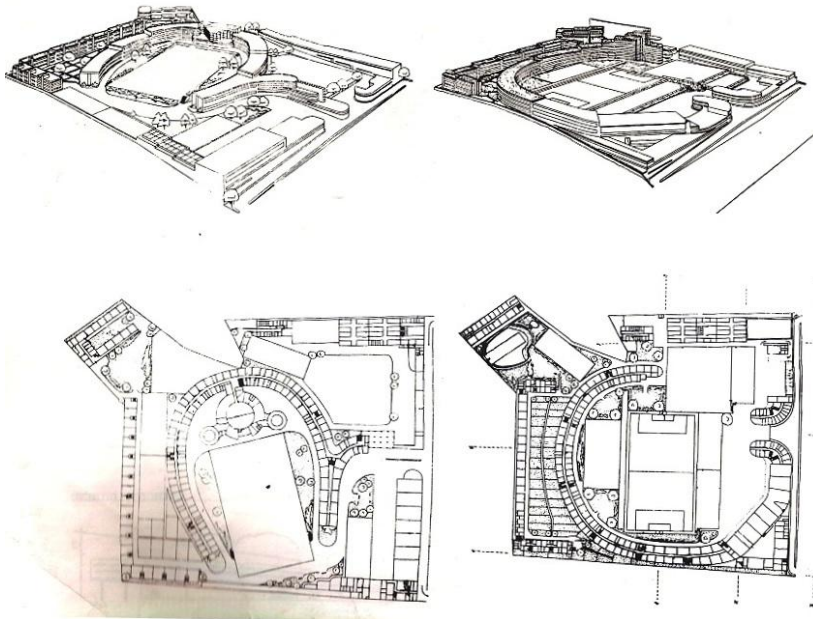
Wettbewerb für eine Staatliche Polizeiunterkunft in Essen. Grundriss eines von drei Entwürfen Rothers.
